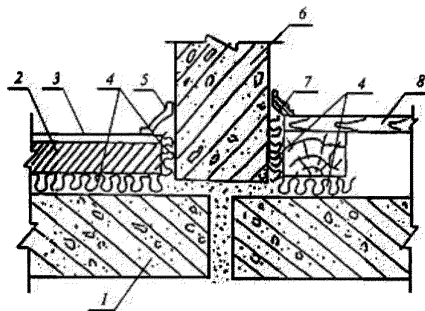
Схема конструктивного решения узла примыкания пола на звукоизоляционном слое к стене (перегородке):
